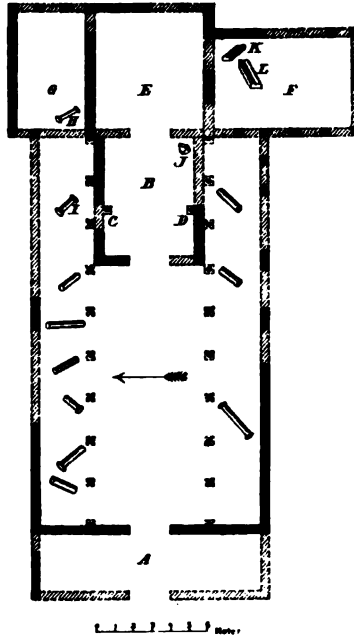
Grundriss der Basilika in Henchir-Seffan.
